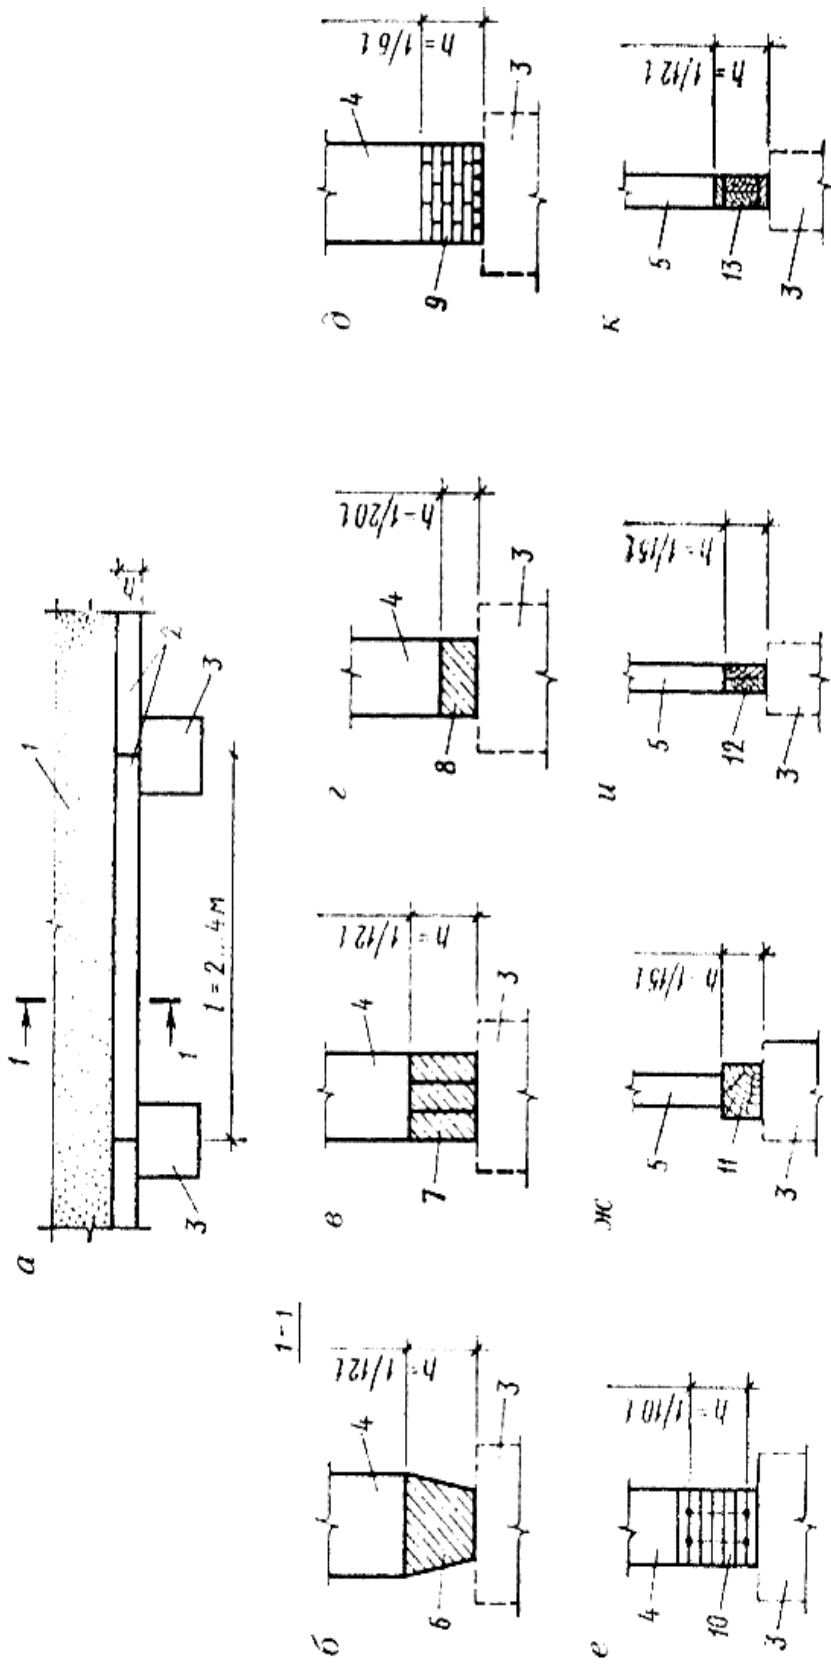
Конструктивні схеми фундаментних балок стовпчастих фундаментів: а – фрагмент загального вигляду стовпчастого фундаменту; б – е – фундаментні балки під кам'яні і дерев'яні стіни; ж – к – фундаментні балки під дерев'яні стіни; 1 – стіна; 2 – фундаментна балка; 3 – стовп; 4 – кам'яна стіна; 5 – дерев'яна стіна; 6 – збірна залізобетонна балка; 7 – збірні залізобетонні перемички, балкові, посилені;
